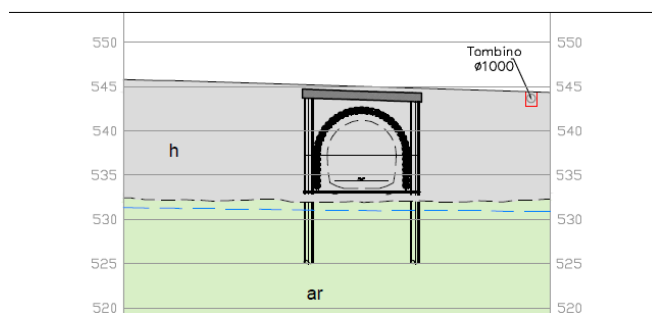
stralcio del Plano-Profilo allegato con la sezione geologica longitudinale e la sezione geologica trasversale dell'imbocco di finestra Funes.
